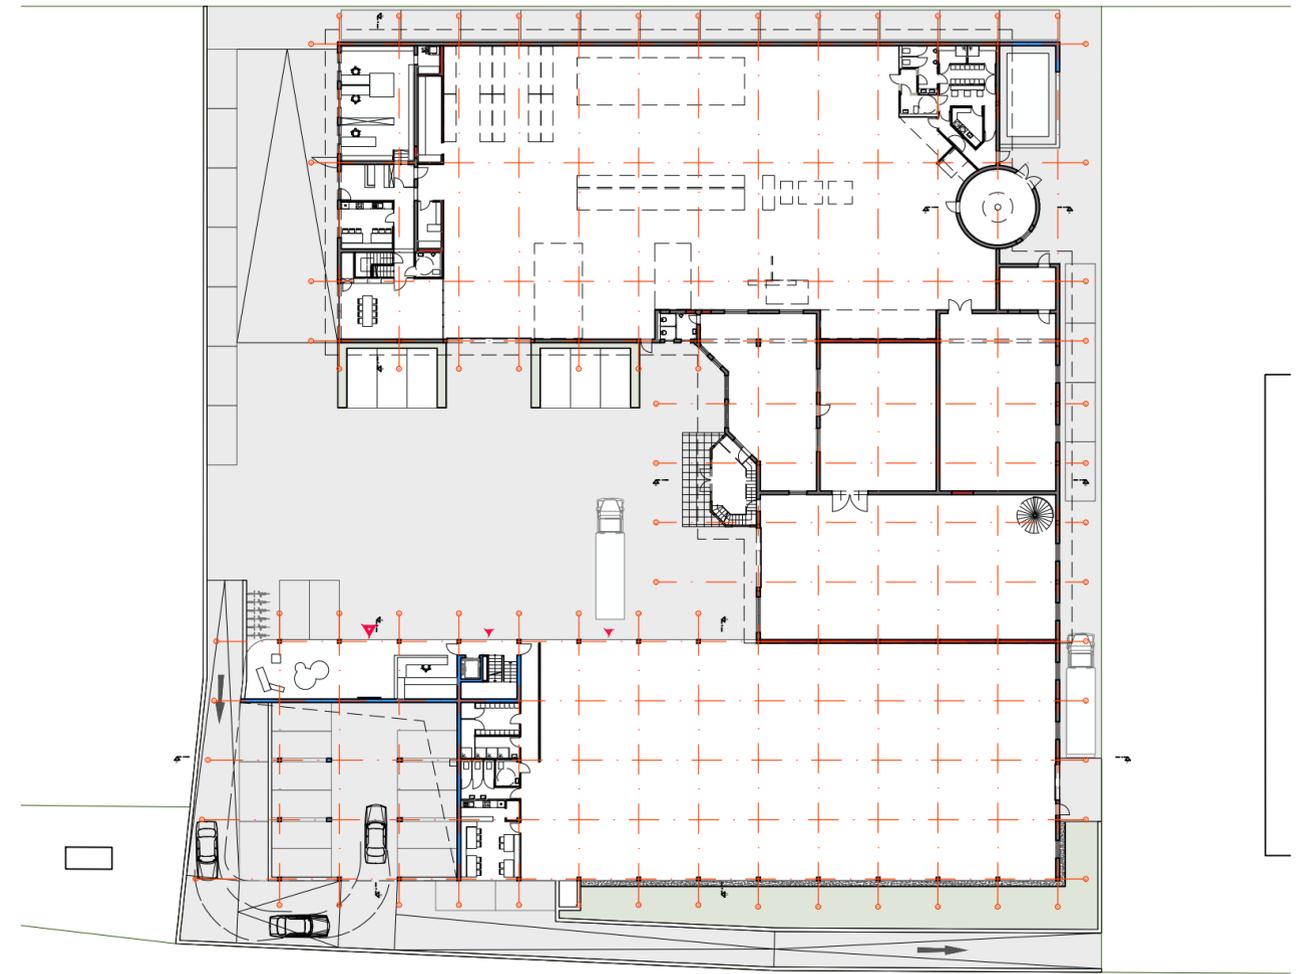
Vorentwurf III - Grundriss Erdgeschoß
